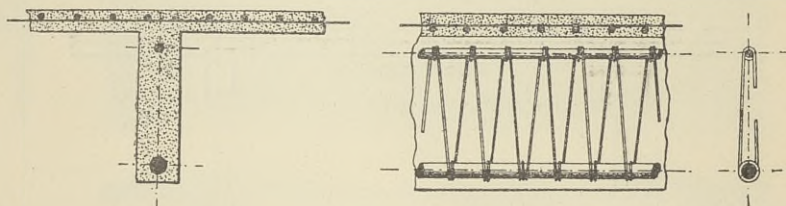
Armature de poutre, système Pavin de Lafarge.
